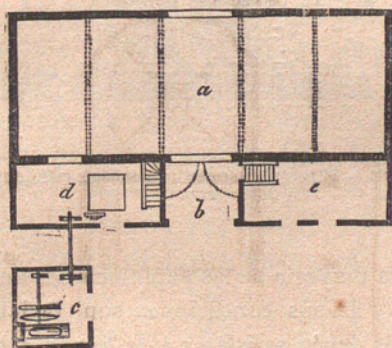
Plano de granja con sitio separado para la máquina de vapor.
